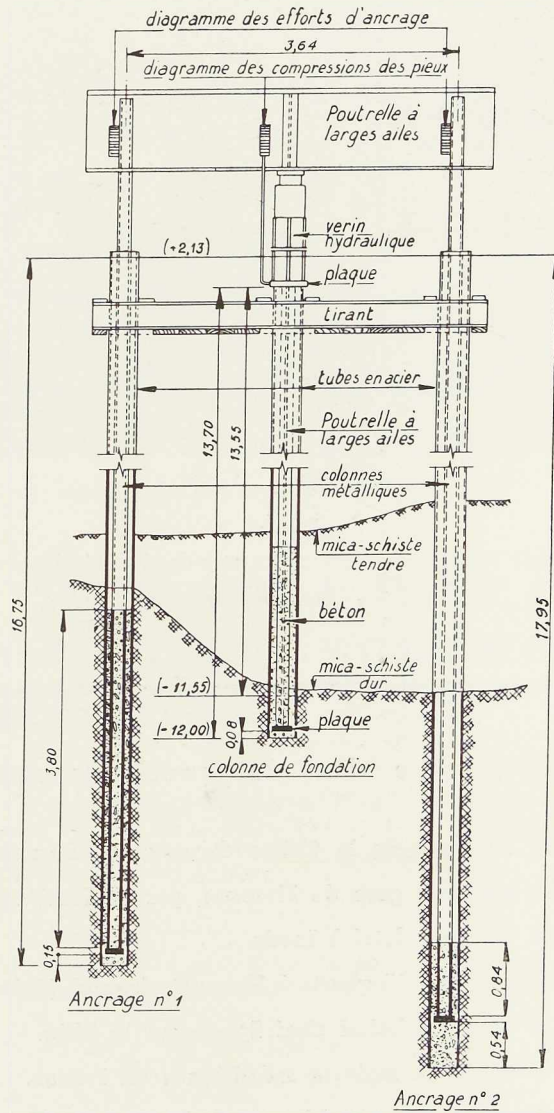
Schéma du dispositif adopté pour l'essai de charge des puits. La colonne d'essai (au milieu) est un modèle à échelle réduite de la colonne du bâtiment. De chaque côté se trouvent les puits d'ancrage servant à maintenir la poutrelle qui reçoit l'action des vérins hydrauliques.
